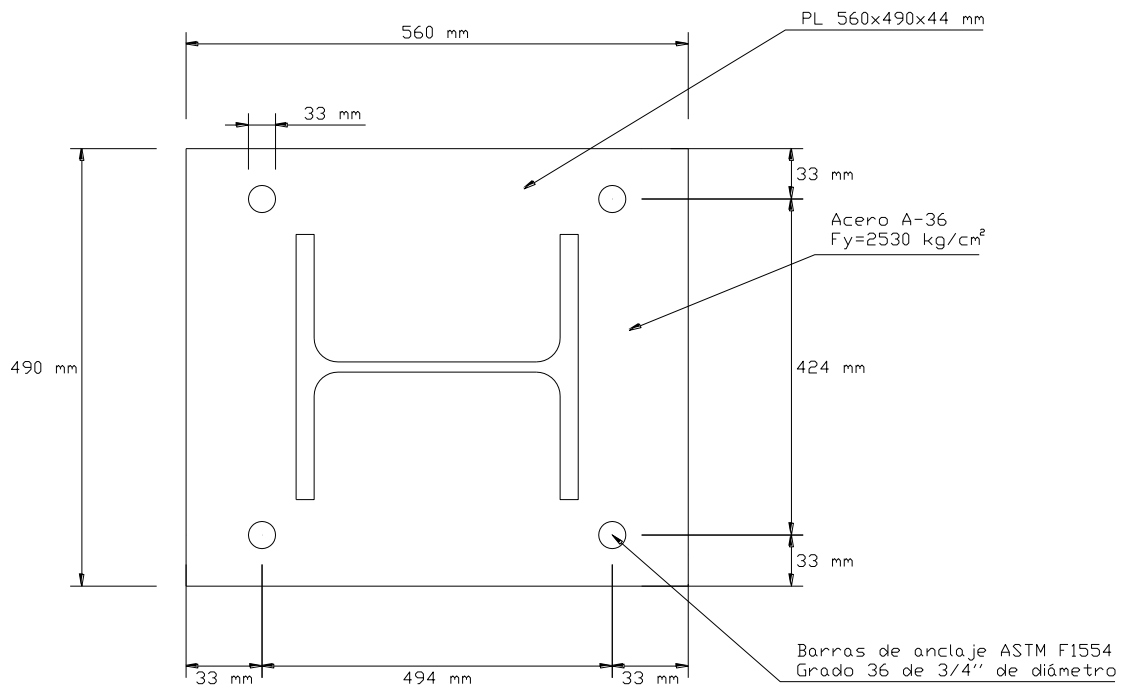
Detallado en Planta del Ejemplo 1.
